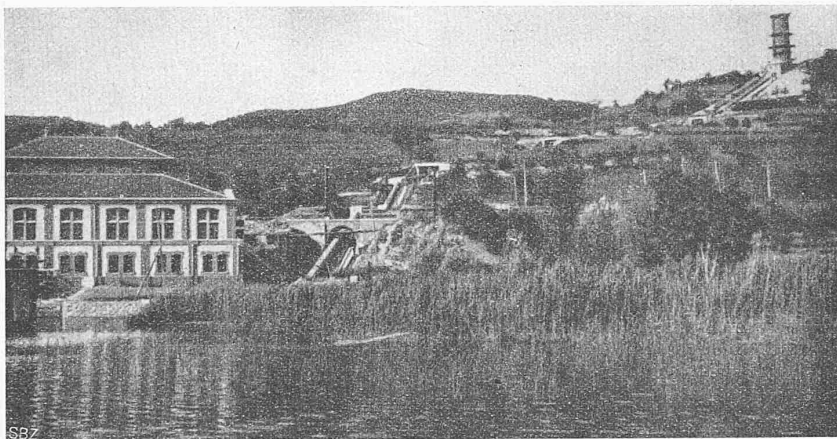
Blick auf Maschinenhaus, Druckleitung und Wasserschloss.
